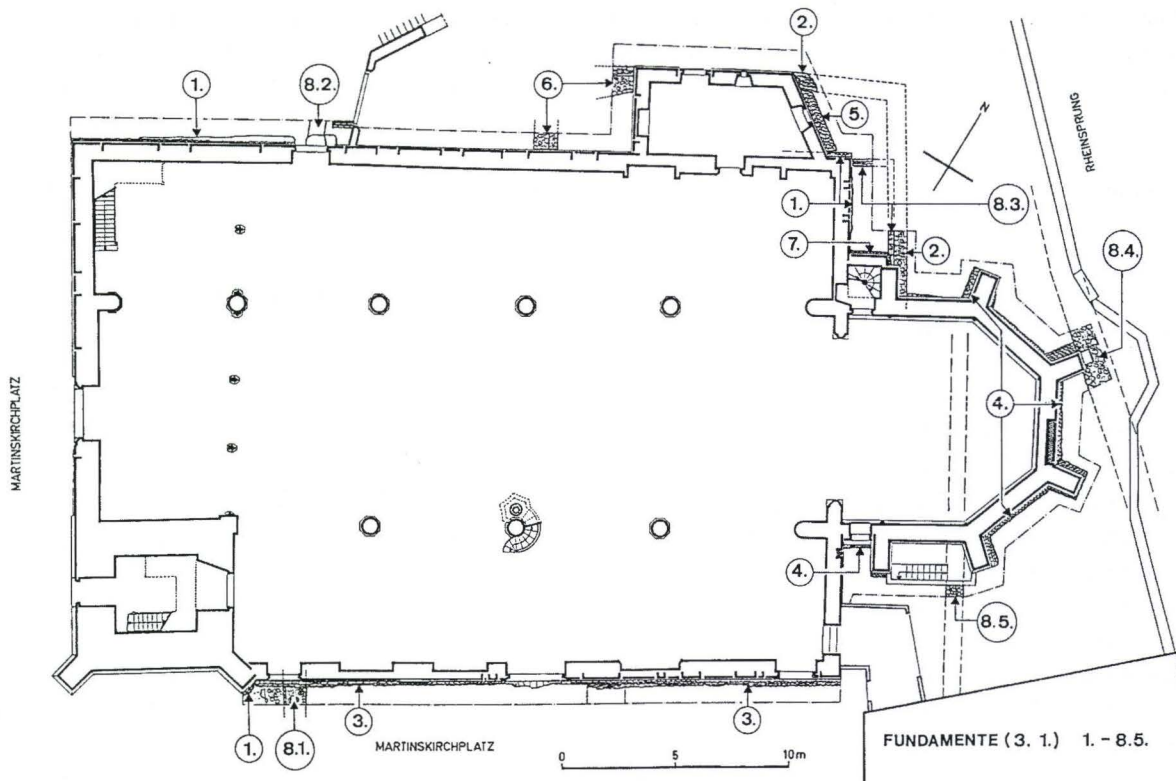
Martinskirche. Grundriss mit den festgestellten Fundamentteilen. – Massstab 1:400.
